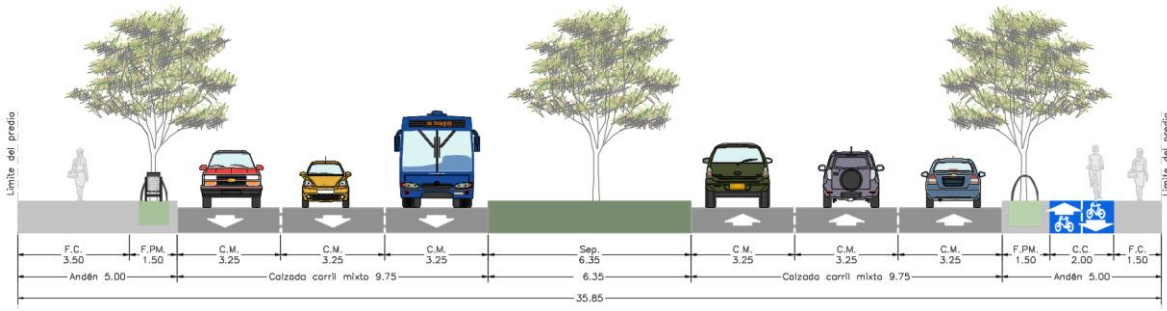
Sección Típica sobre la Av. 1 de Mayo entre La Av. Ciudad Villavicencio y la Autopista Sur. Fuente: Elaboración Propia 2017.
